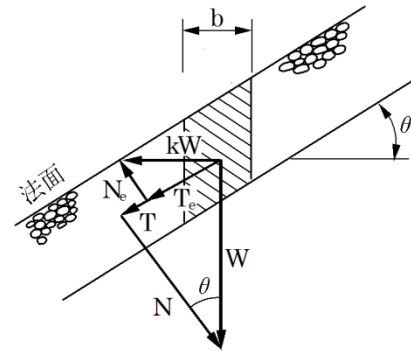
無限斜面の単位体積に作用する力 (空虚地震時)
